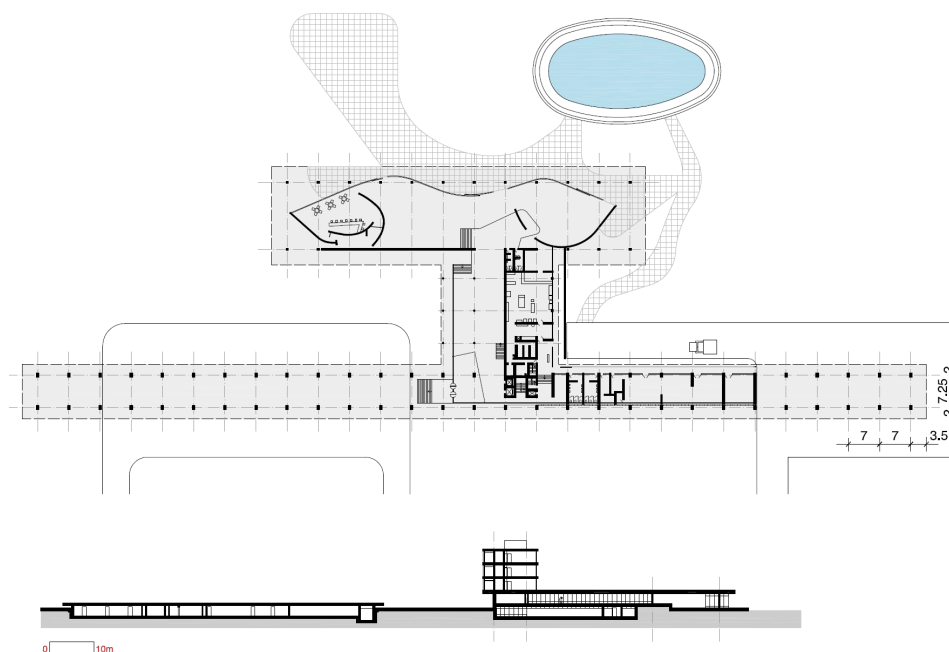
Brasília Palace Hotel, 1956. Planta baixa do térreo e corte transversal.
